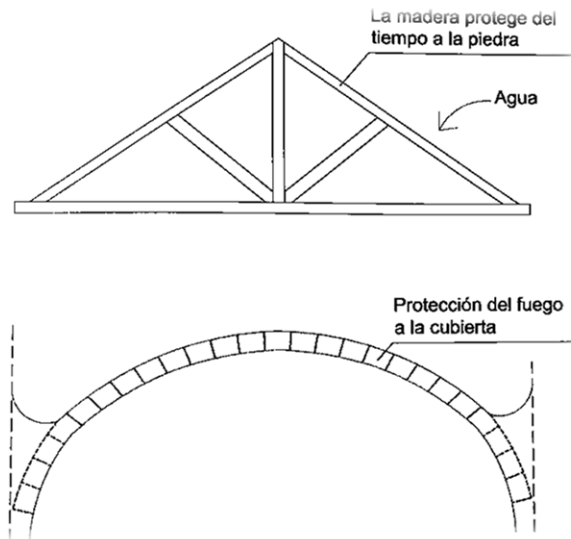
Planteamiento racional de una estructura gótica y cubierta.
